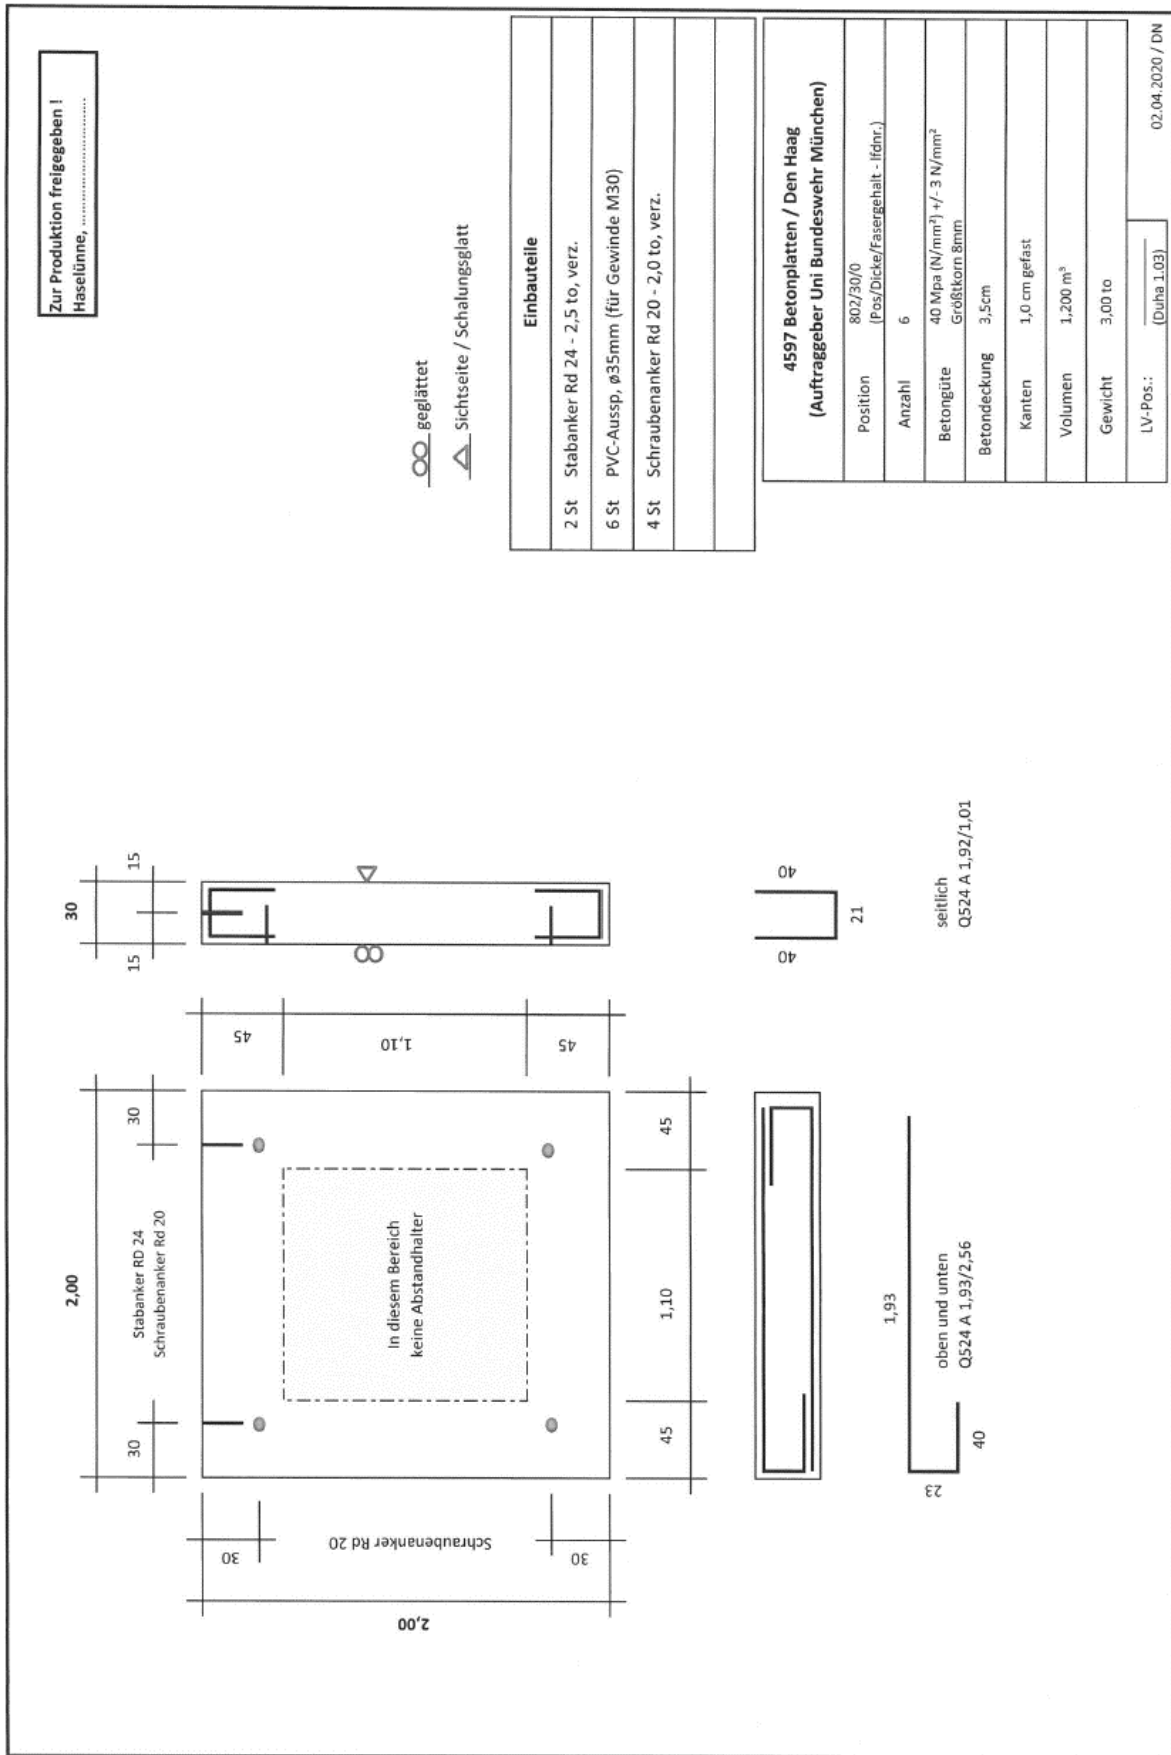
Bewehrungsplan für Stahlbetonplatten (d = 30 cm).
